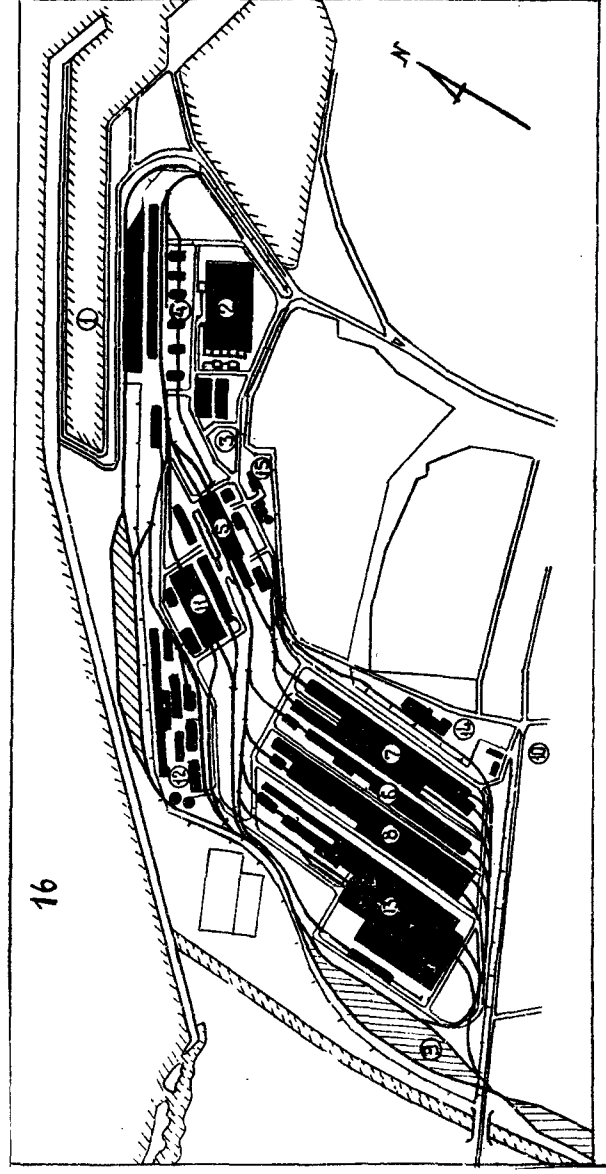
Завод фирмы «ЛЮМОР» в Дюнкерке (Франция): 1 - внутренняя галерея; 2 - усреднительный склад; 3 - агломерационная фабрика; 4 - доменный пех; 5 - кислородно-конвертерный пех № 1; 6 - окислитель-окислитель; 7 - толкательный стан; 8 - непрерывный широкосортный стан горячей прокатки; 9 - сортировочная станция; 10 - заводоуправление; 11 - кислородно-конвертерный пех № 2; 12 - коксохимический пех (вторая очередь строительства); 13 - территория для расширения прокатных цехов; 14 - трубный пех; 15 - хозяйство водоснабжения; 16 - Северное море
